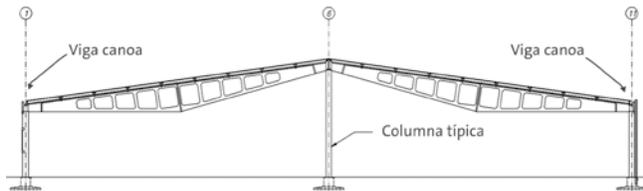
Marco típico con vigas de alma abierta y pendiente del 14% en techos
